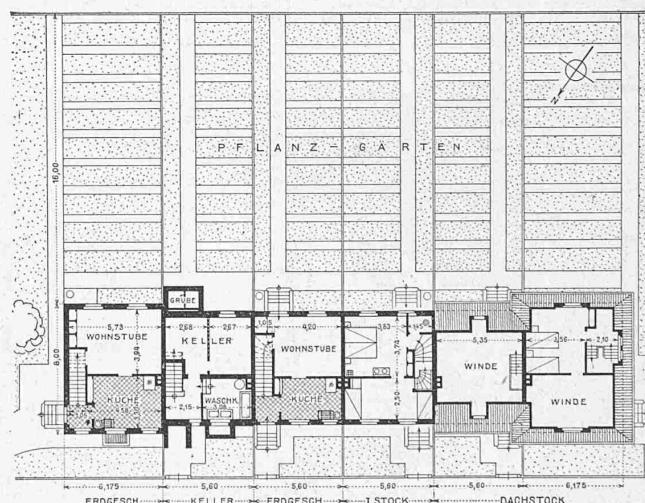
Grundrisse einer Sechshäusergruppe. — Maßstab 1 : 400.
